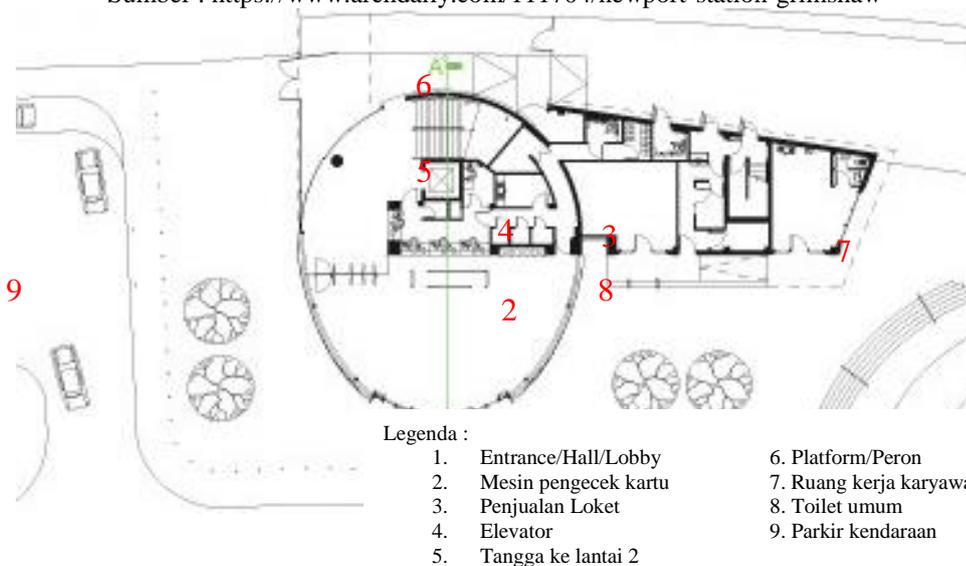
Floor Plan stasiun Gubeng Baru
